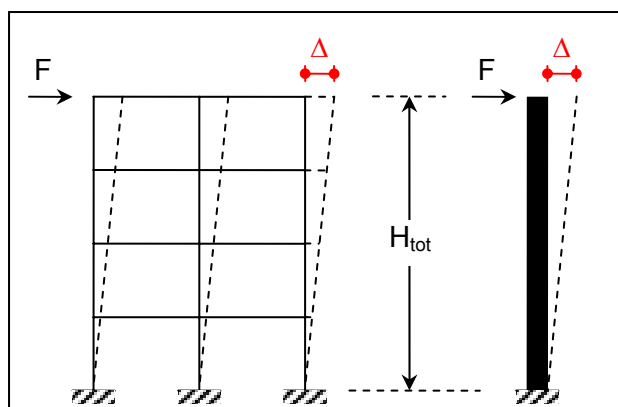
Rigidez do pilar equivalente – estrutura de contraventamento
